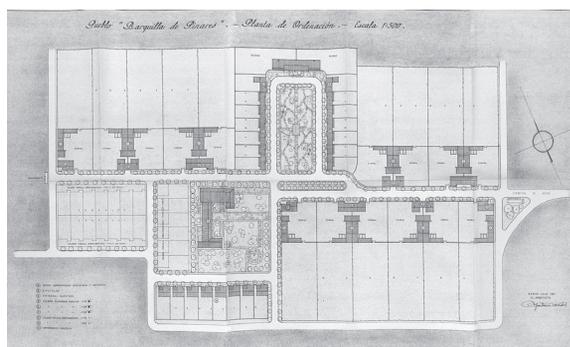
Barquilla de Pinares. Planta de ordenación (ACMAGRAMA).
